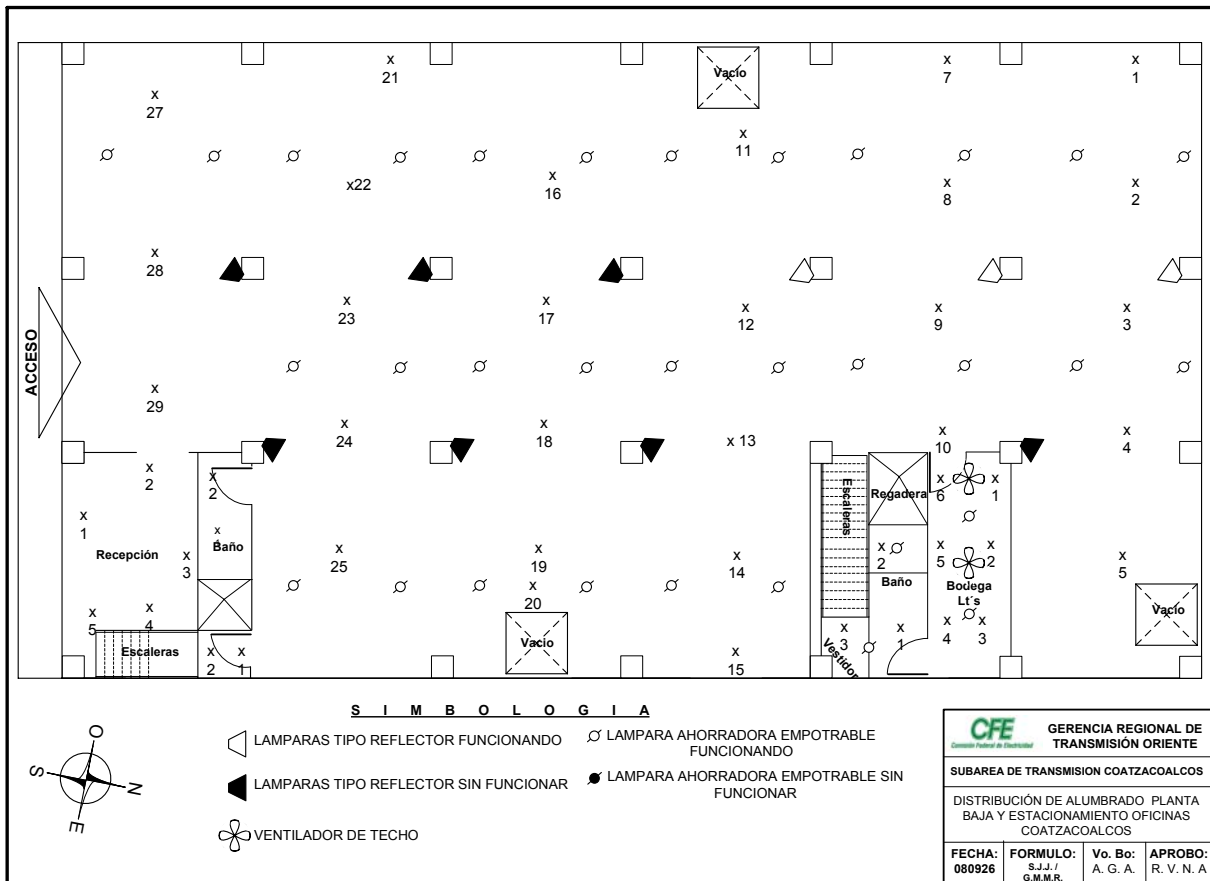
Medición de los niveles de iluminación edificio de la Subárea (Planta baja- estacionamiento).
